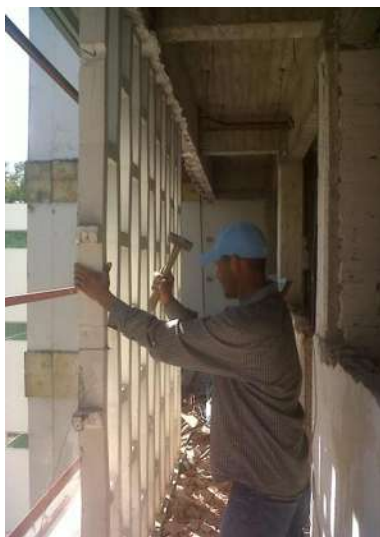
DESMANTELAMIENTO DE CELOSÍA FACHADA EN EL 3ER PISO.
